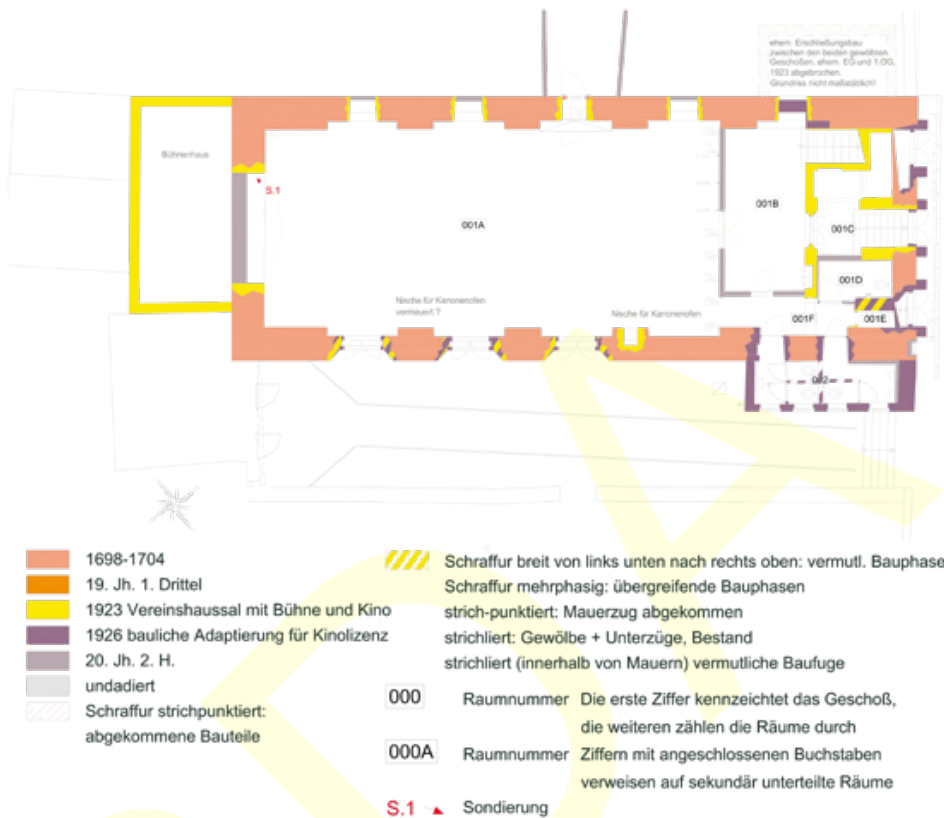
Retz, Schüttkasten. Baualterplan des Erdgeschoßes.
